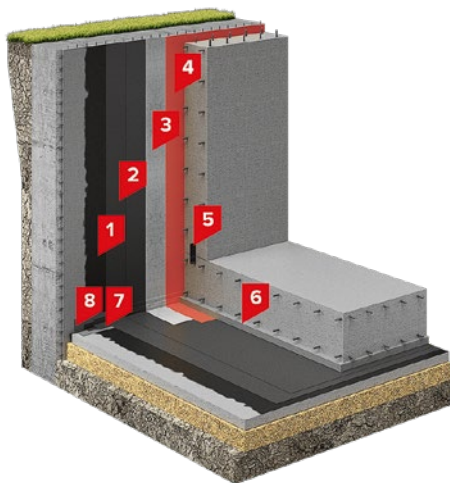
Система ТН-ФУНДАМЕНТ СВГ Оптима. Обустройство гидроизоляционной мембраны, укладываемой методом наплавления в котлованах с вертикальным ограждением
